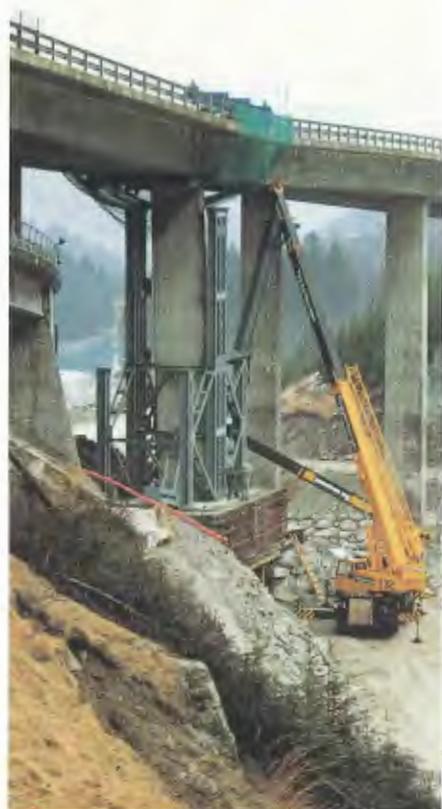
Montage des Stahlgerüsts mit Pneukran ab Baupiste linkes Reussufer
